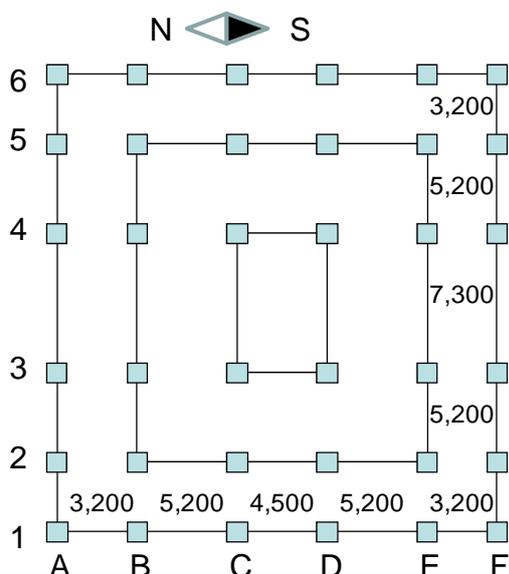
王宮型ジョグロの Srimanganti Hall の柱配置図 (単位: mm)
